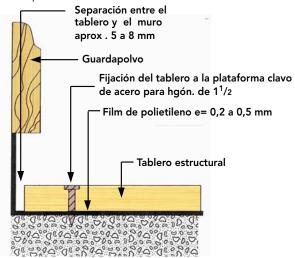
Fijación del tablero estructural a la plataforma de hormigón.
